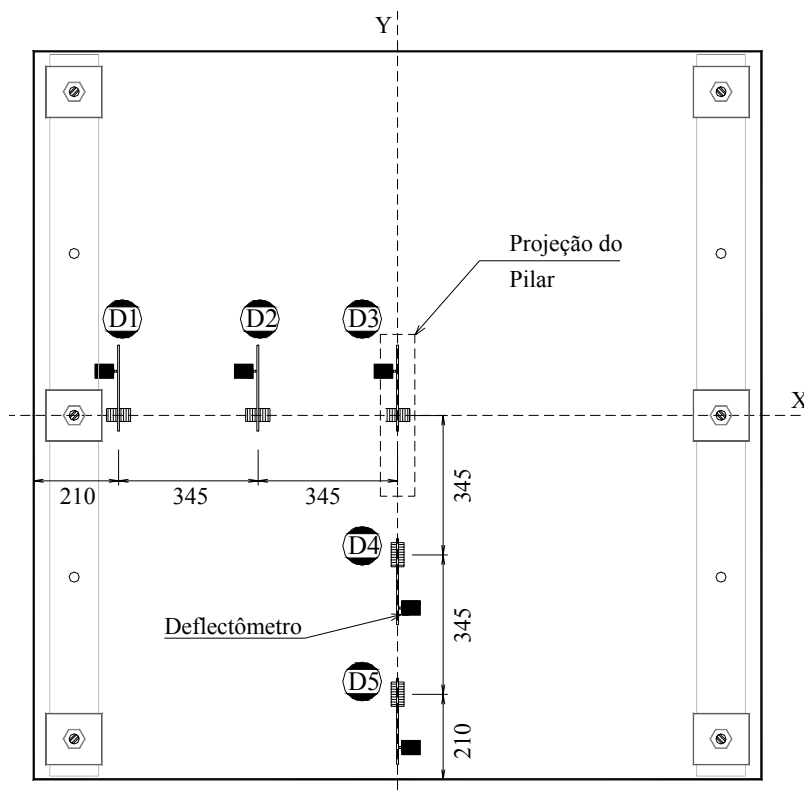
Detalhe da instalação dos deflectômetros nas lajes
